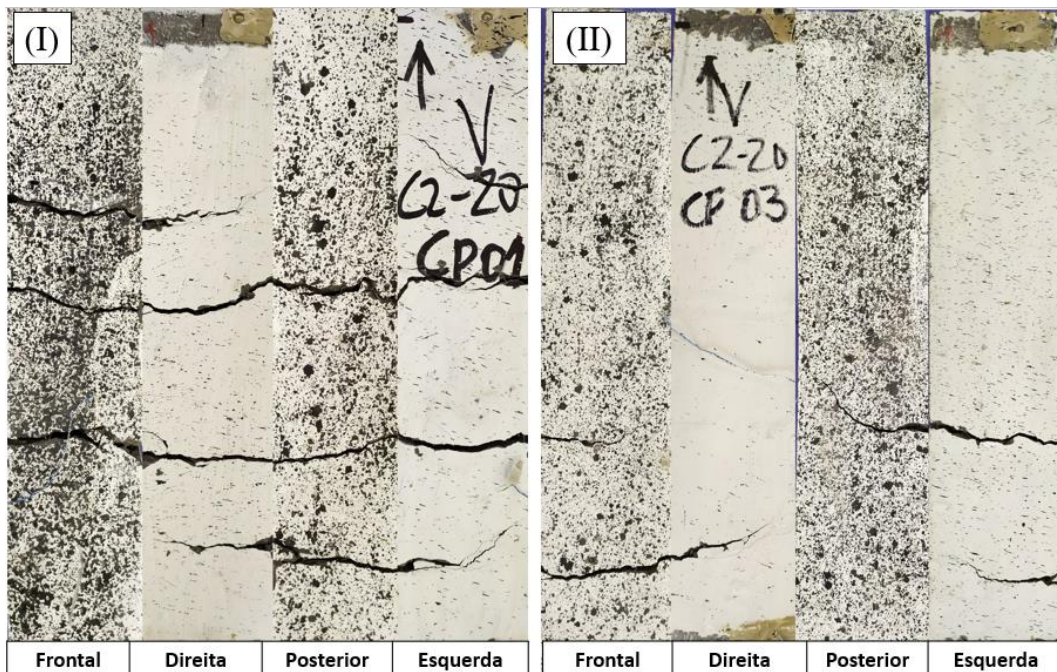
Mapas de fissuras do grupo C1.V.20.
